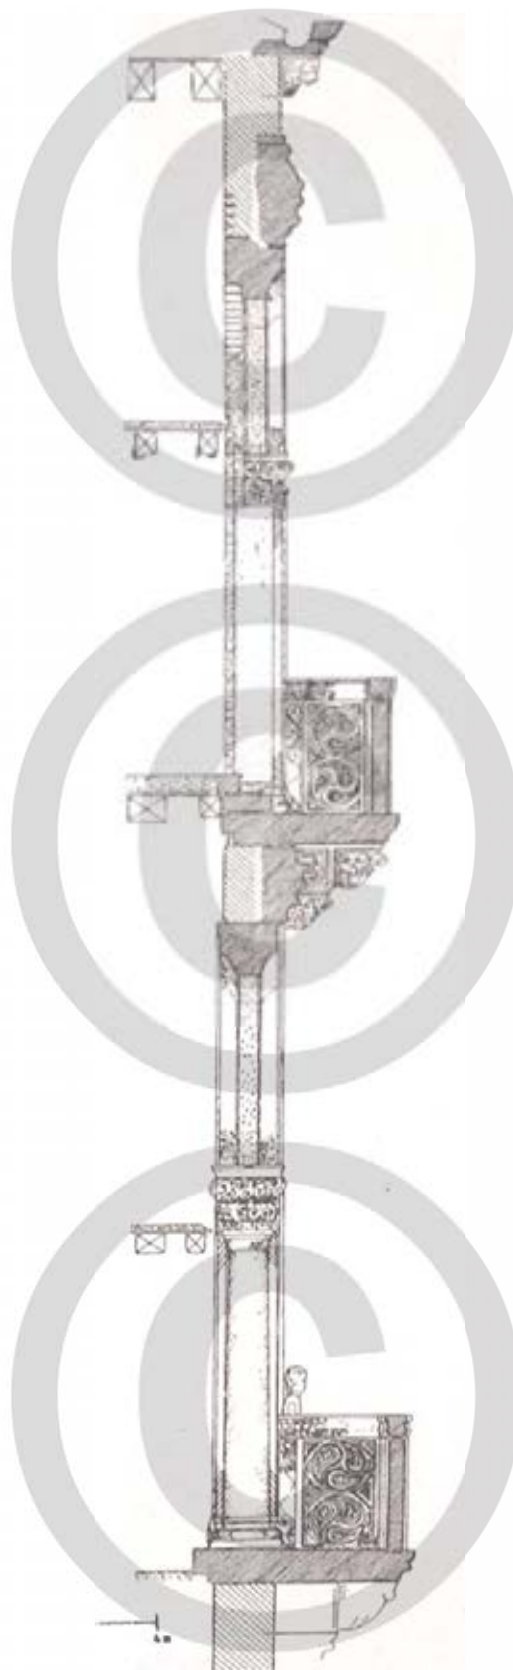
Sección de la fachada de Ca' Contarini Fasan. (Schuller)
